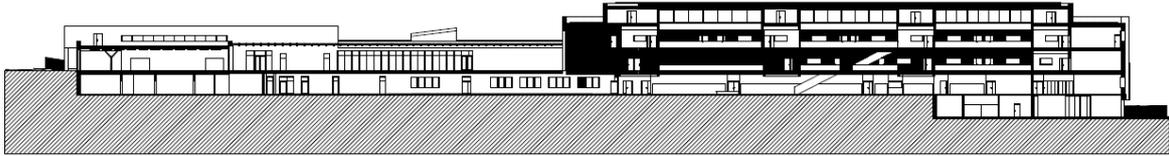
Coupe longitudinale ouest-est du futur projet (source : Eiffage)
